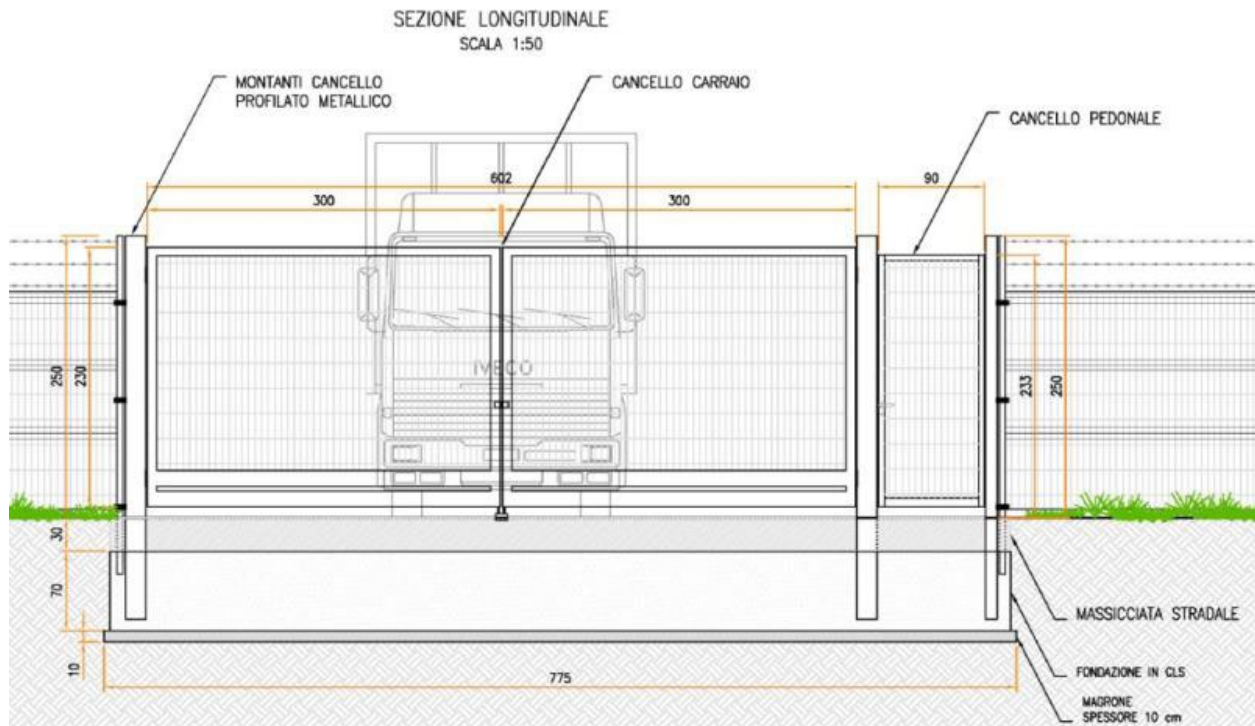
Sezione longitudinale accesso carraio e pedonale
